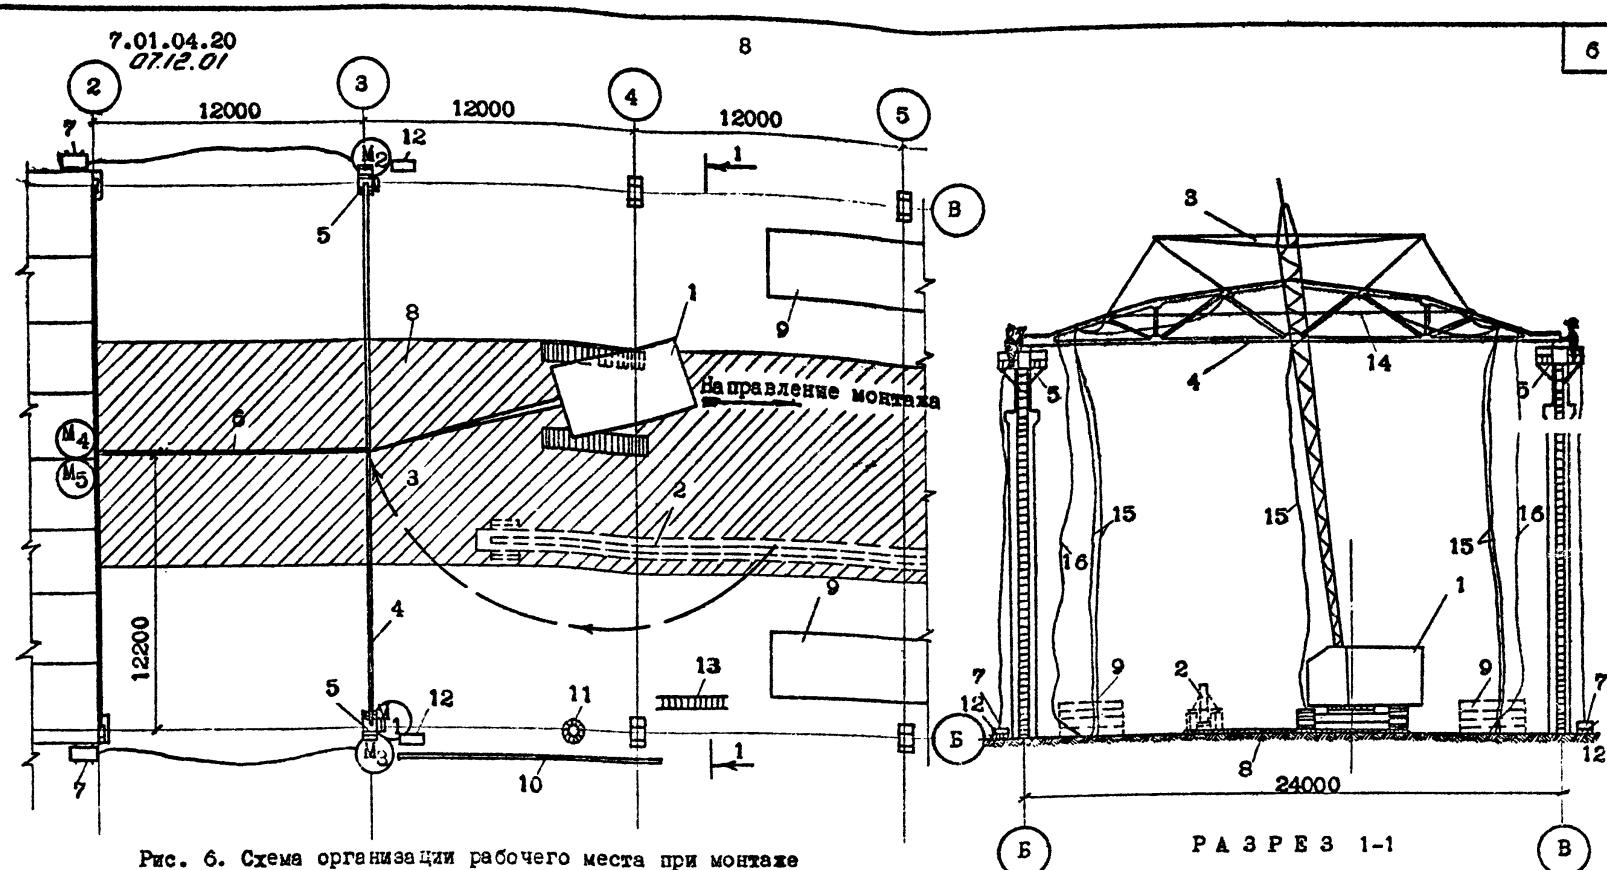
Схема организации рабочего места при монтаже стропильных ферм.
